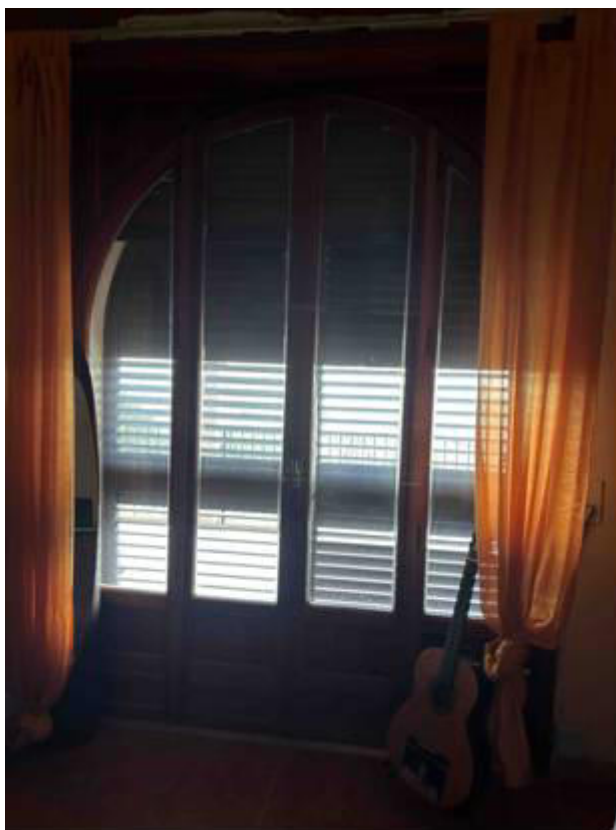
Foto scattata all’infisso in legno a 4 ante con vetro singolo.
